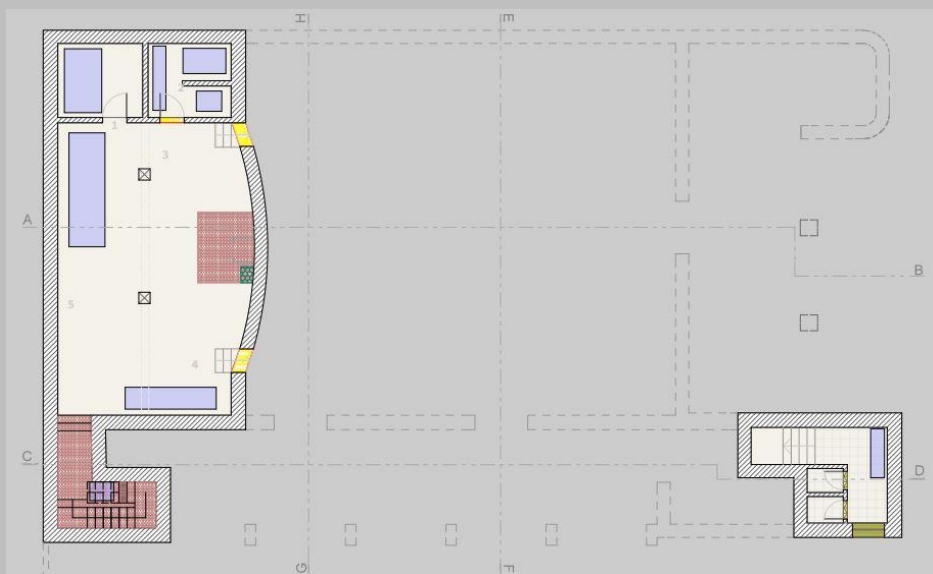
Estado Conservação Planta Piso -1, Pedro Santos 2017
